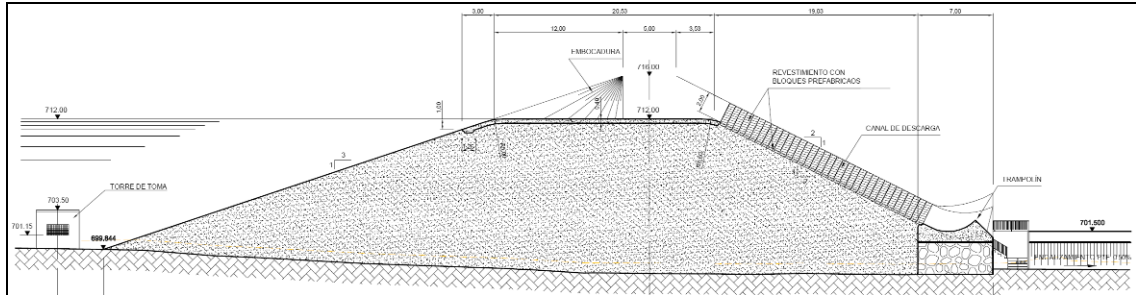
Sección tipo de la presa de Barriga por el aliviadero
